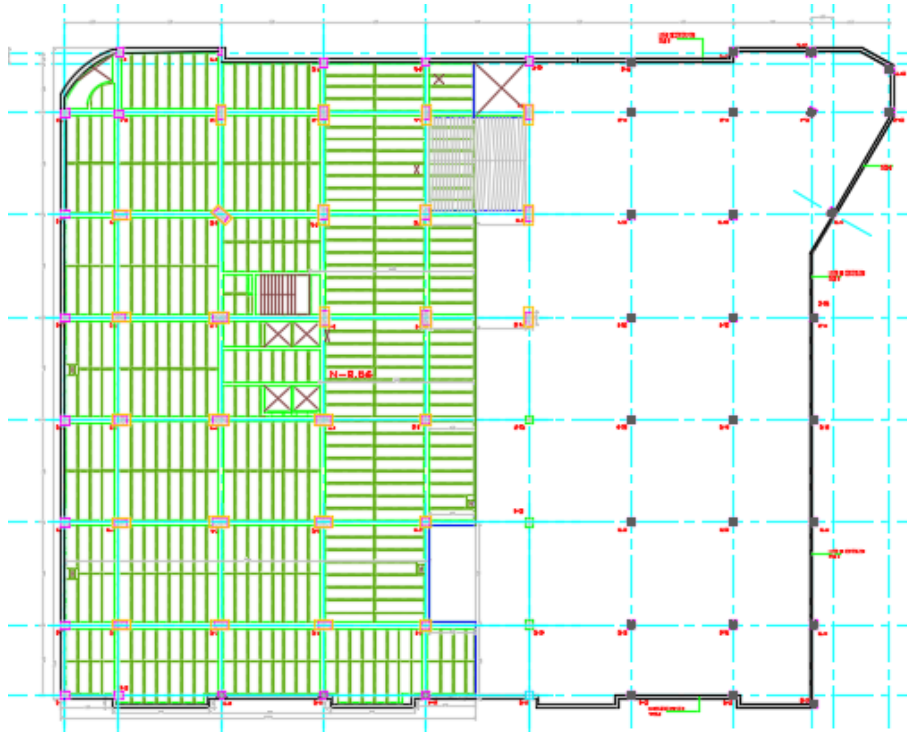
Planta estructural losa tipo N-250,N-550, N-850, N-1150.
